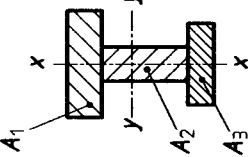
Geometría y distribución de tensiones en las vigas compuestas
